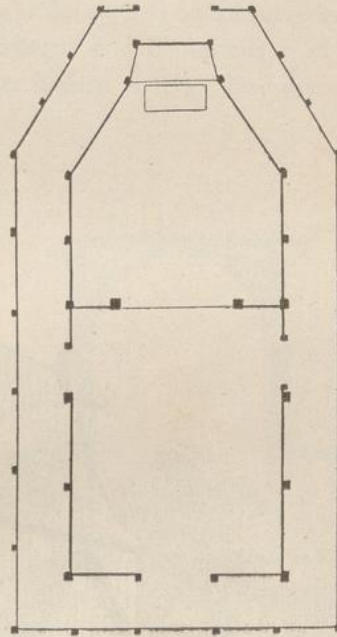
Grundriss der Kirche zu Braunau.
